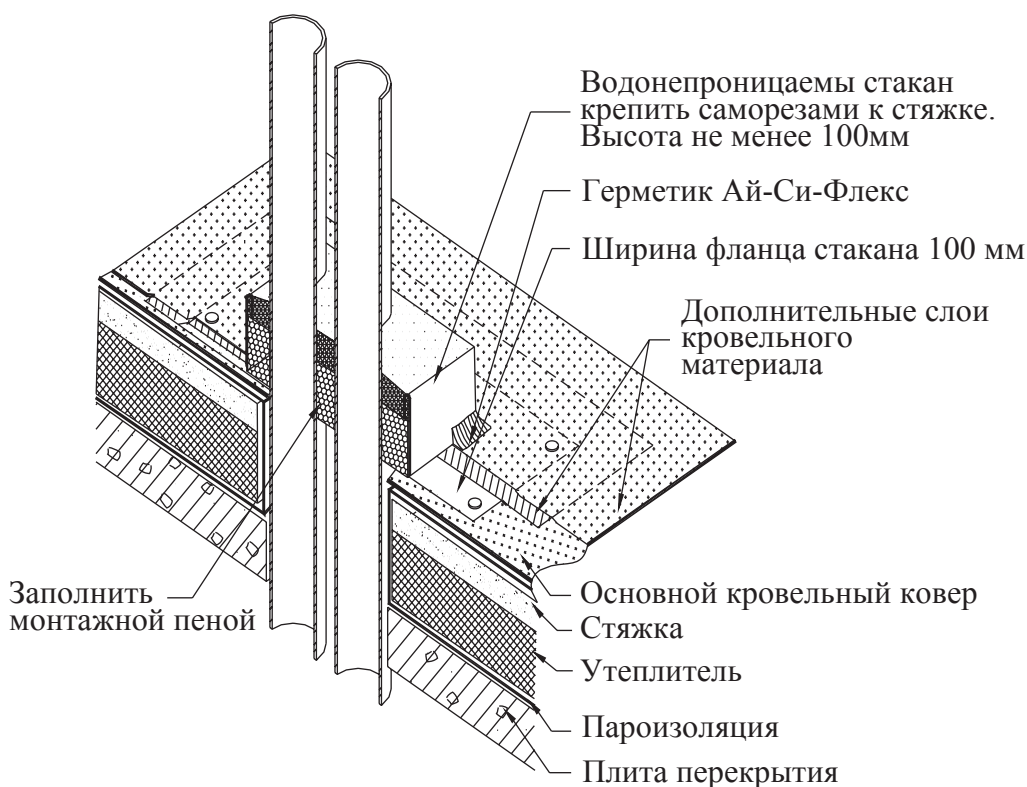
Примыкание гидроизоляционного ковра к пучку труб малого диаметра.
